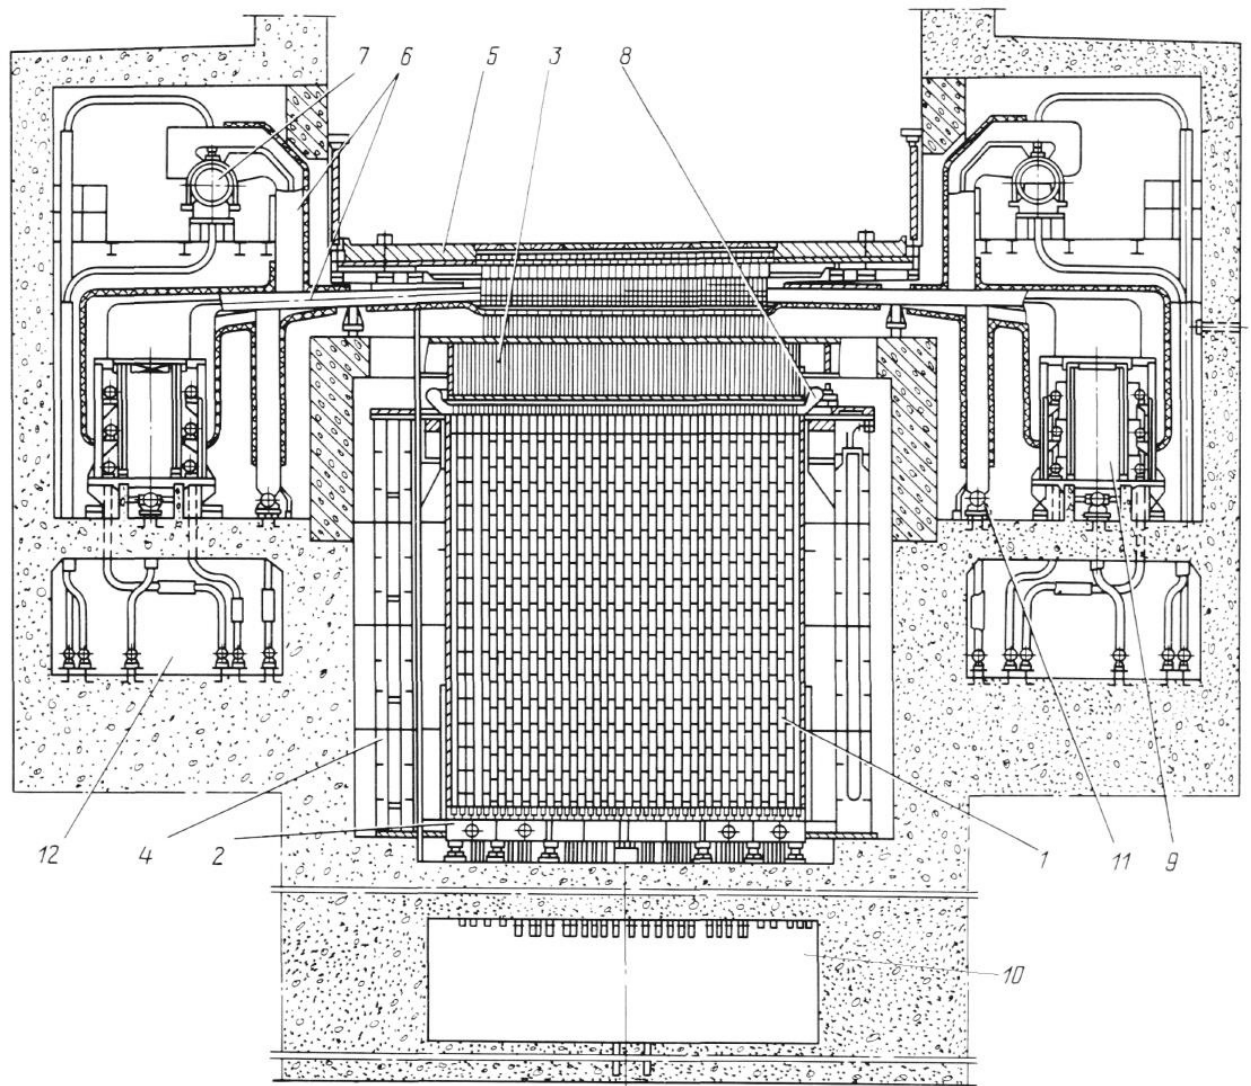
Продольный разрез реактора блока № 2 БЕЛАЭС:
